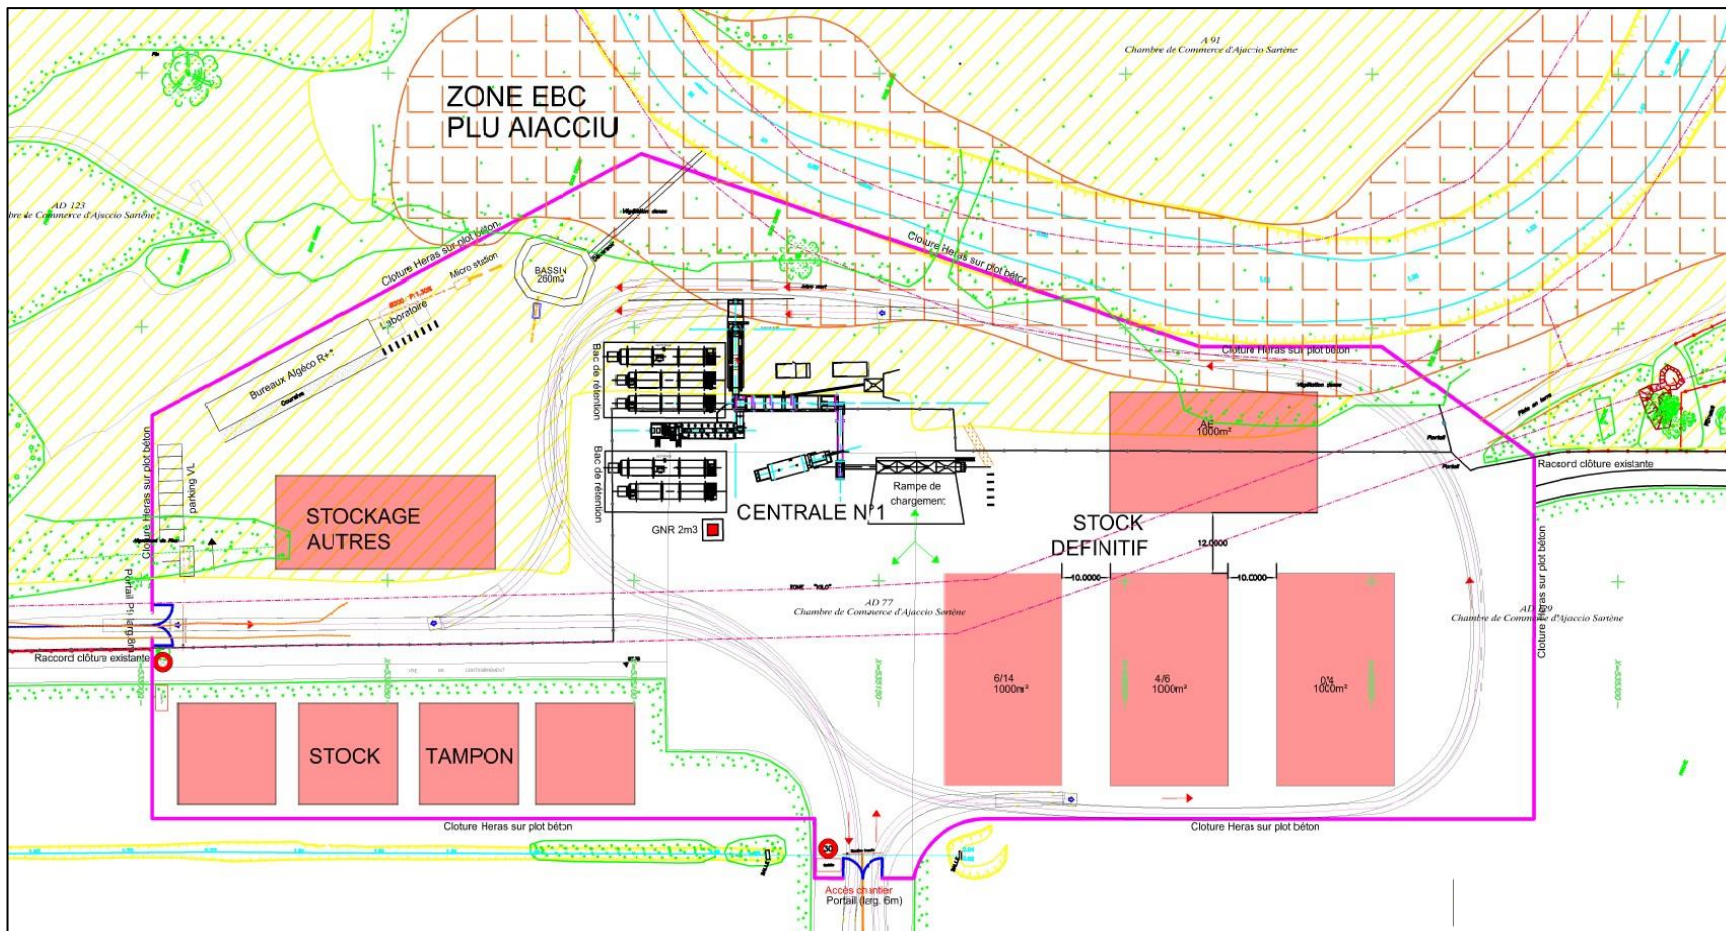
Plan de principe de la zone d'installation de la base travaux (Source : Collectivité de Corse)
